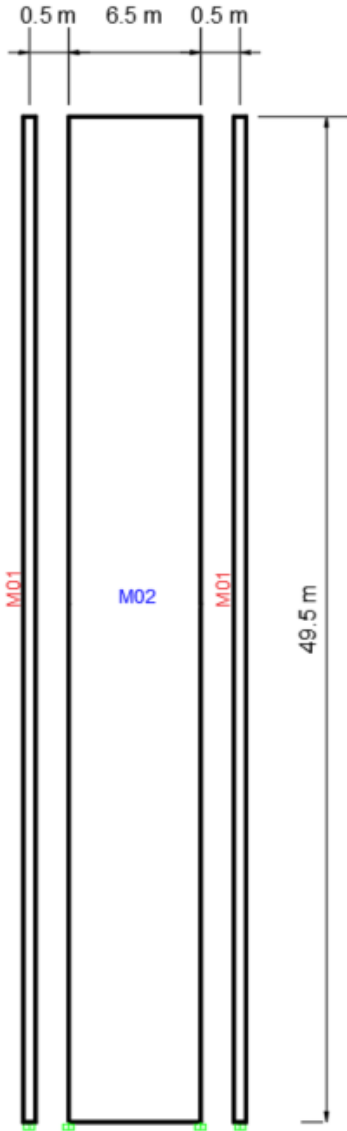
Elevación Eje 3' Edificio 16 Pisos
